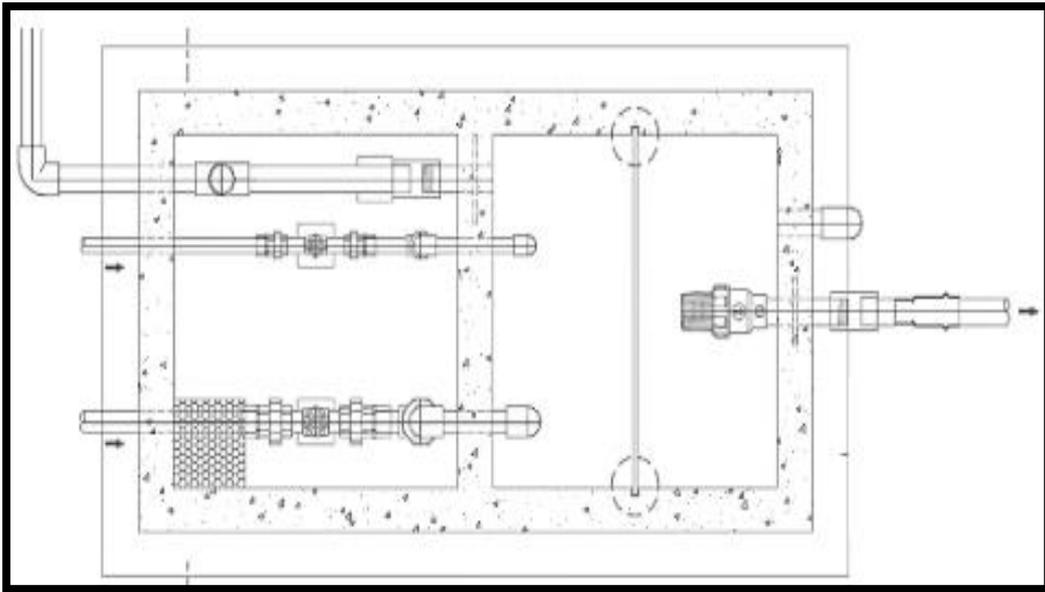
Plano en planta de Cámara de Reunión de Caudales
